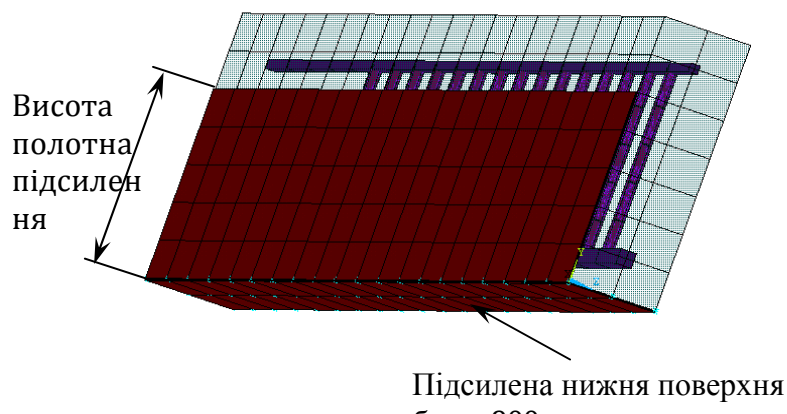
Схема підсилення СЕ моделі залізобетонної балки
